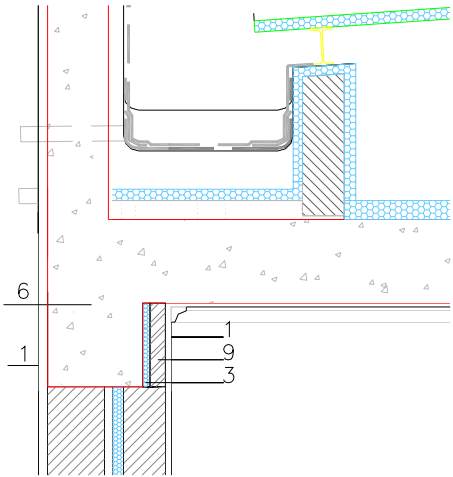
Ligação da fachada com a cobertura (corte vertical).
